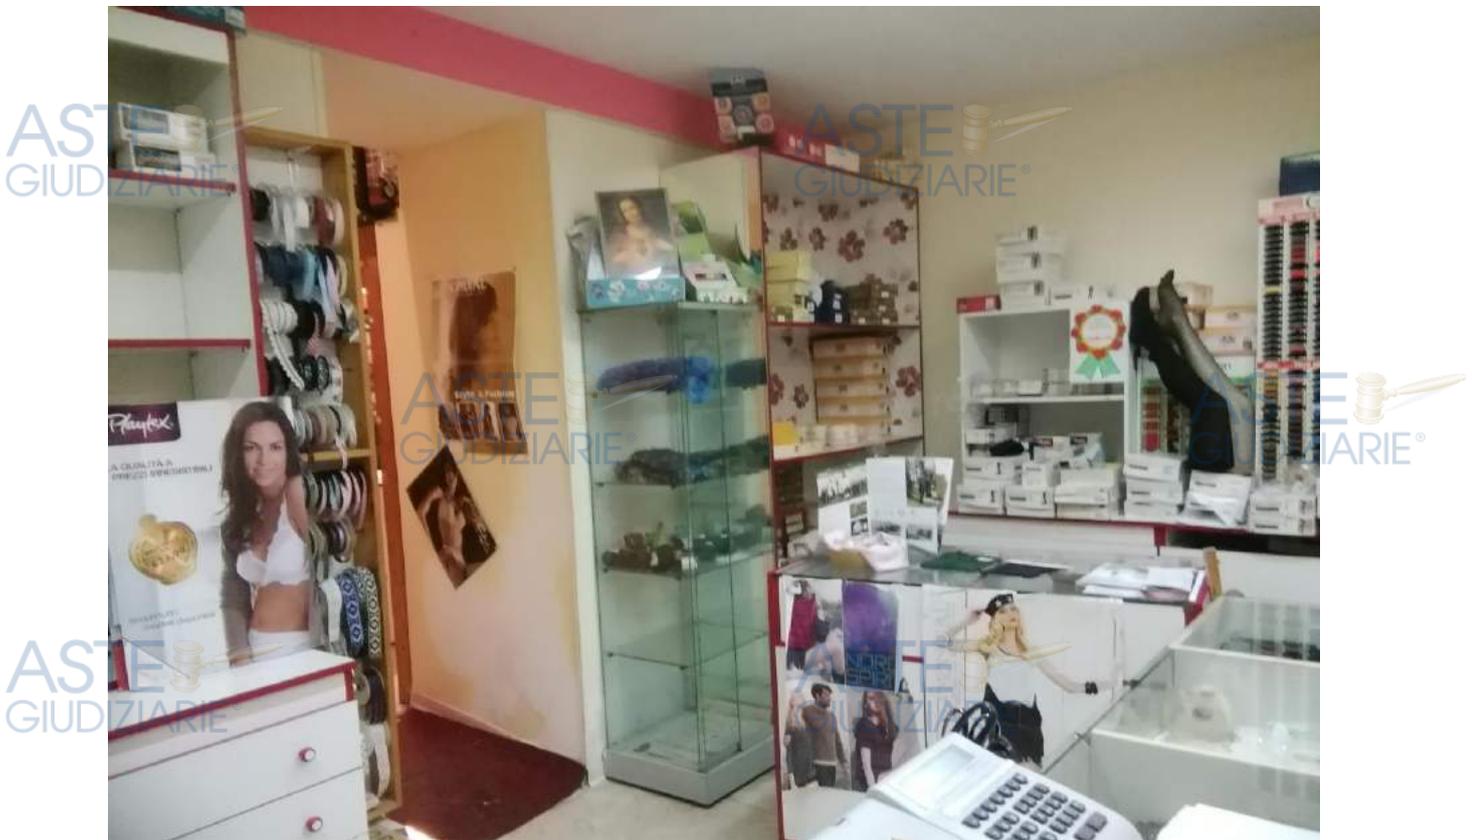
Apertura di comunicazione subalterno 4 con subalterno 1
